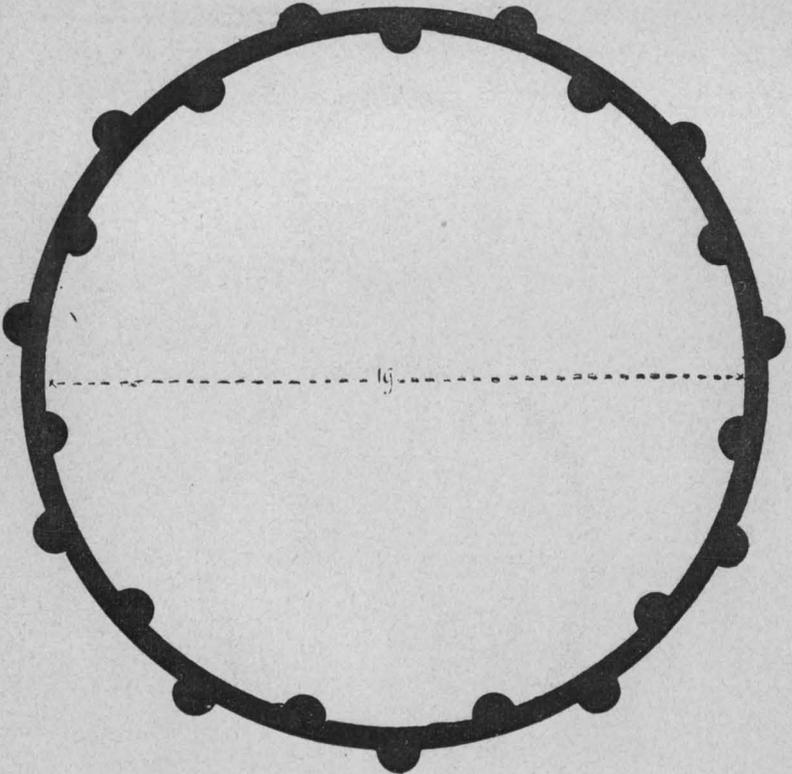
FESGÜET-EDDAITYA. Plan.
